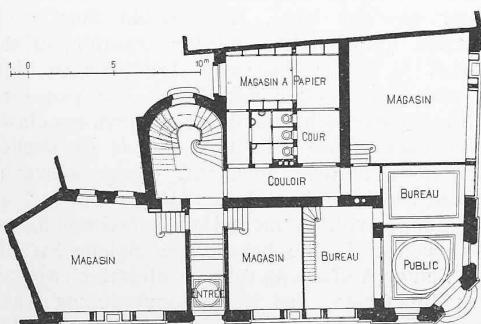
Maison Wolfrath. — Plan du rez-de-chaussée. — 1:400.
